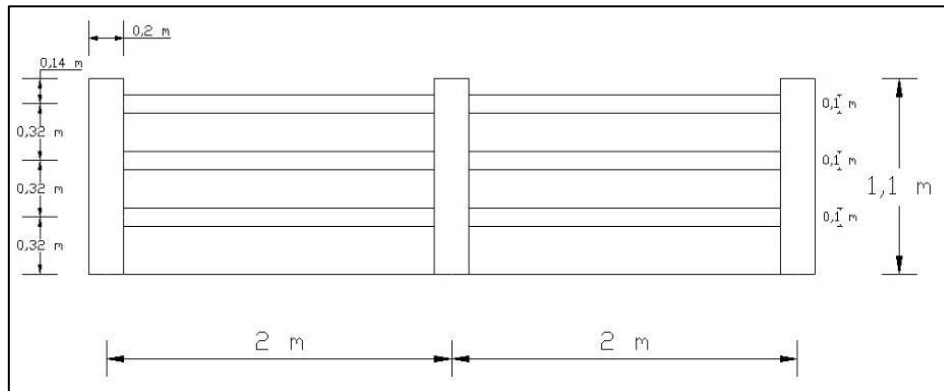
Detalle de la Sección Longitudinal de la Protección Lateral
